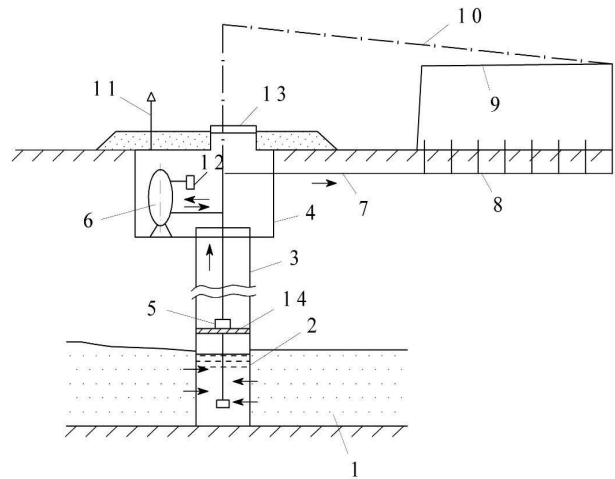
Схема локального водопровода при подаче воды из шахтного колодца: 1 – водоносный пласт; 2 – фильтр; 3 – стенки шахтного колодца; 4 – подземное помещение; 5 – горизонтальный электронасос; 6 – водонапорный пневматический резервуар; 7 – водовод; 8 – водопроводная сеть; 9 – линия требуемых напоров в сети; 10 – пьезометрическая линия в час максимального водопотребления; 11 – вентиляционная труба; 12 – реле давления; 13 – крышка; 14 – железобетонная площадка
